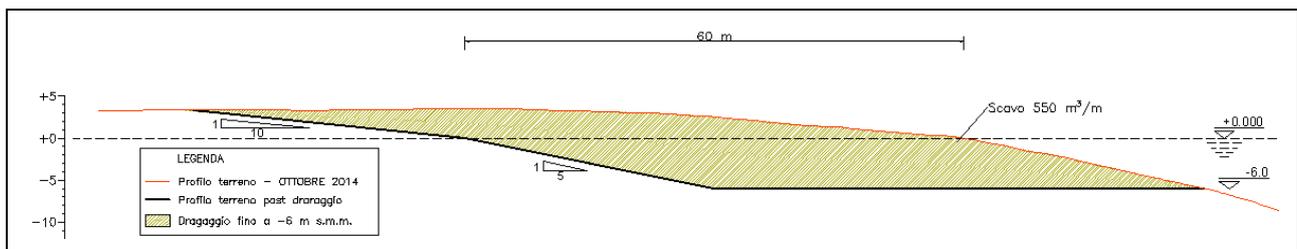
Sezione di dragaggio in corrispondenza del tratto più a Sud (sezione X-X').
